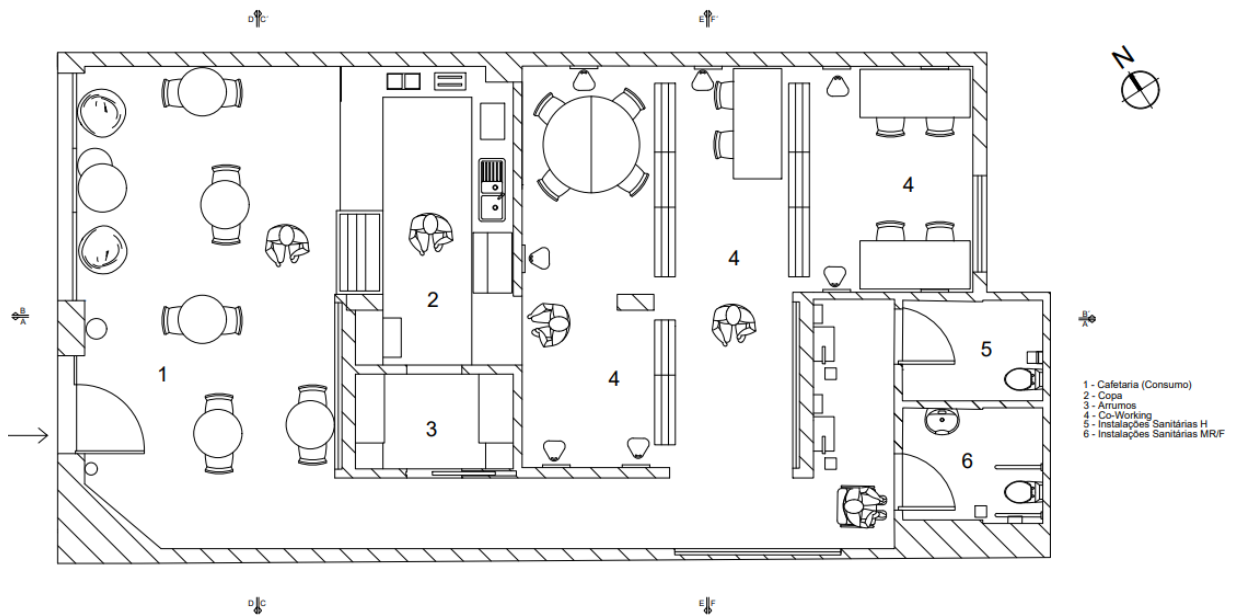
Planta de apresentação. Fonte: Rafael Costa
